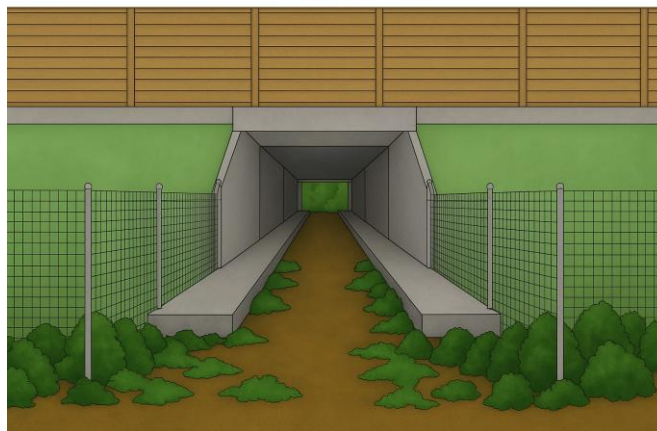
Ejemplo de cerramiento hasta aletas de alcantarilla. Fuente: Generada con IA
